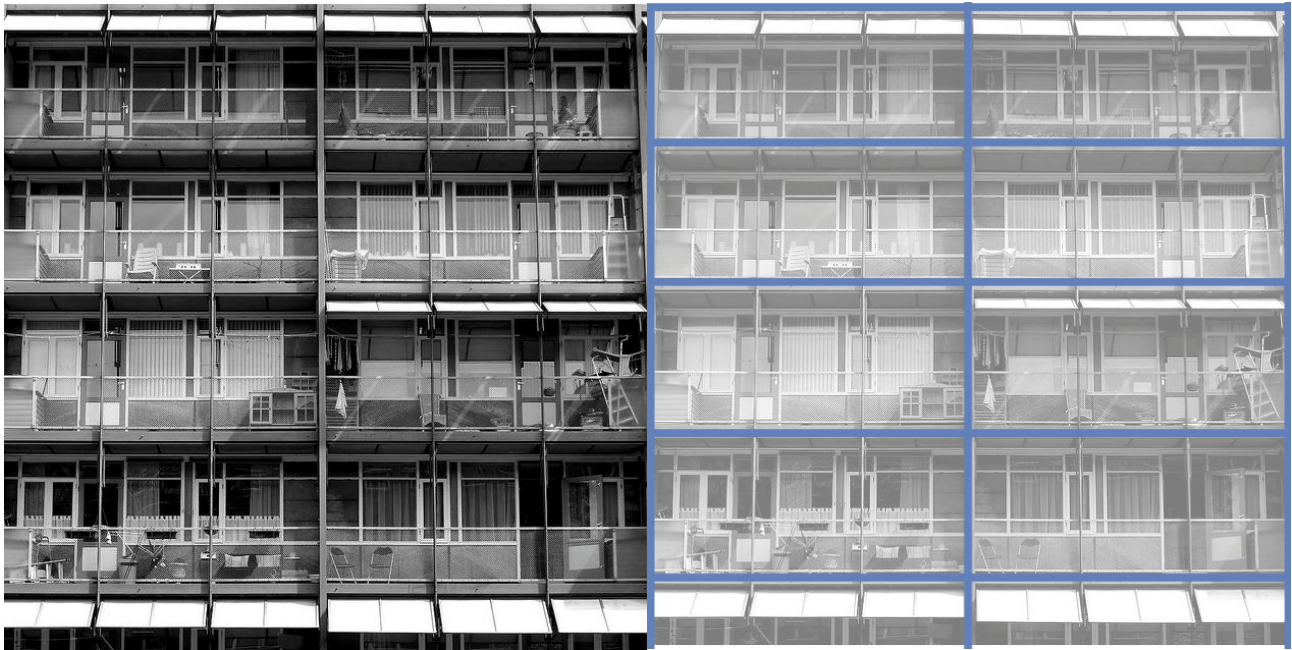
Imagen de la fachada de las terrazas. A la derecha, con entramado estructural. Diseño de la autora.
